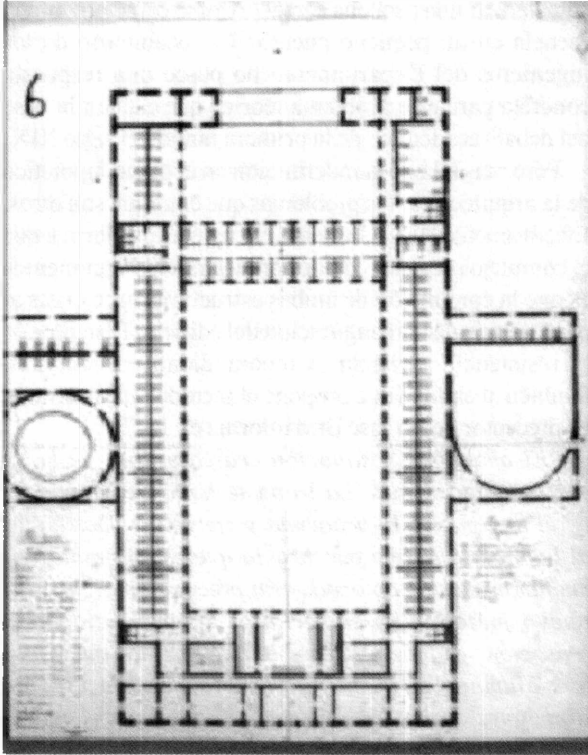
Planta superior del Colegio con Internado para señoritas. Anteproyecto de Carlo Zucchi. Fuente: ASRE AZ
